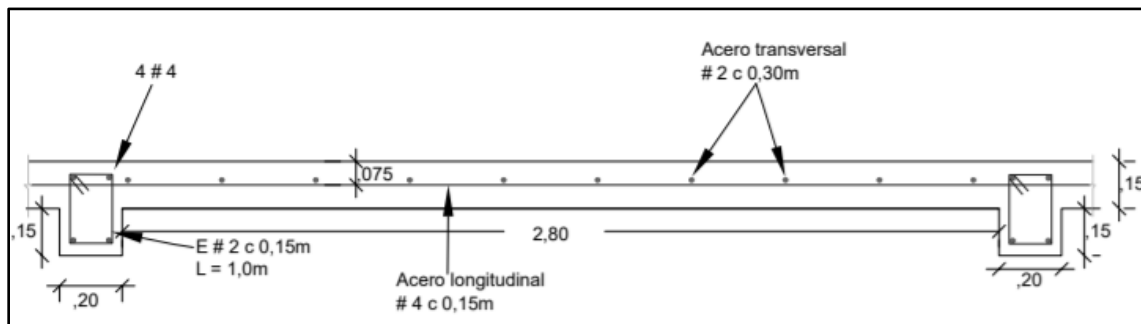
Planta de Distribución del Refuerzo en una Placa-huella.
